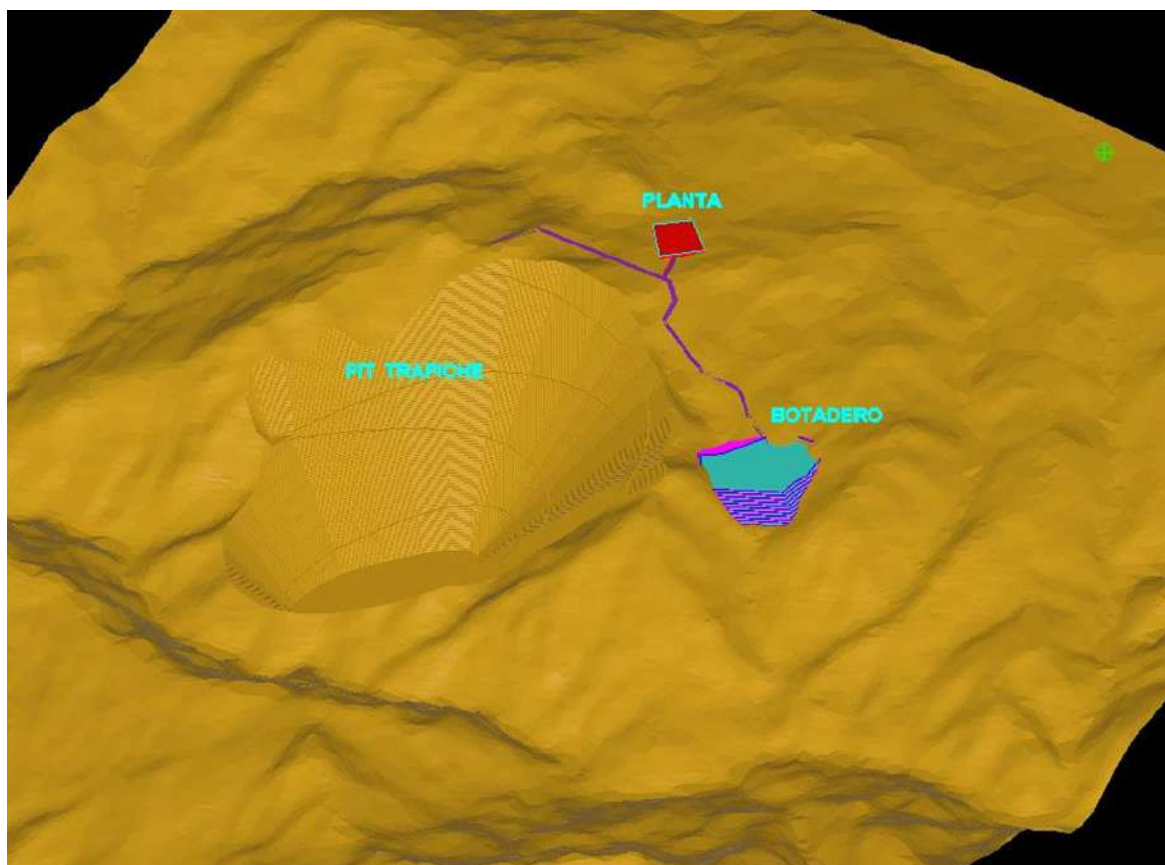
Botadero, plantas chancado y el Pit Trapiche
